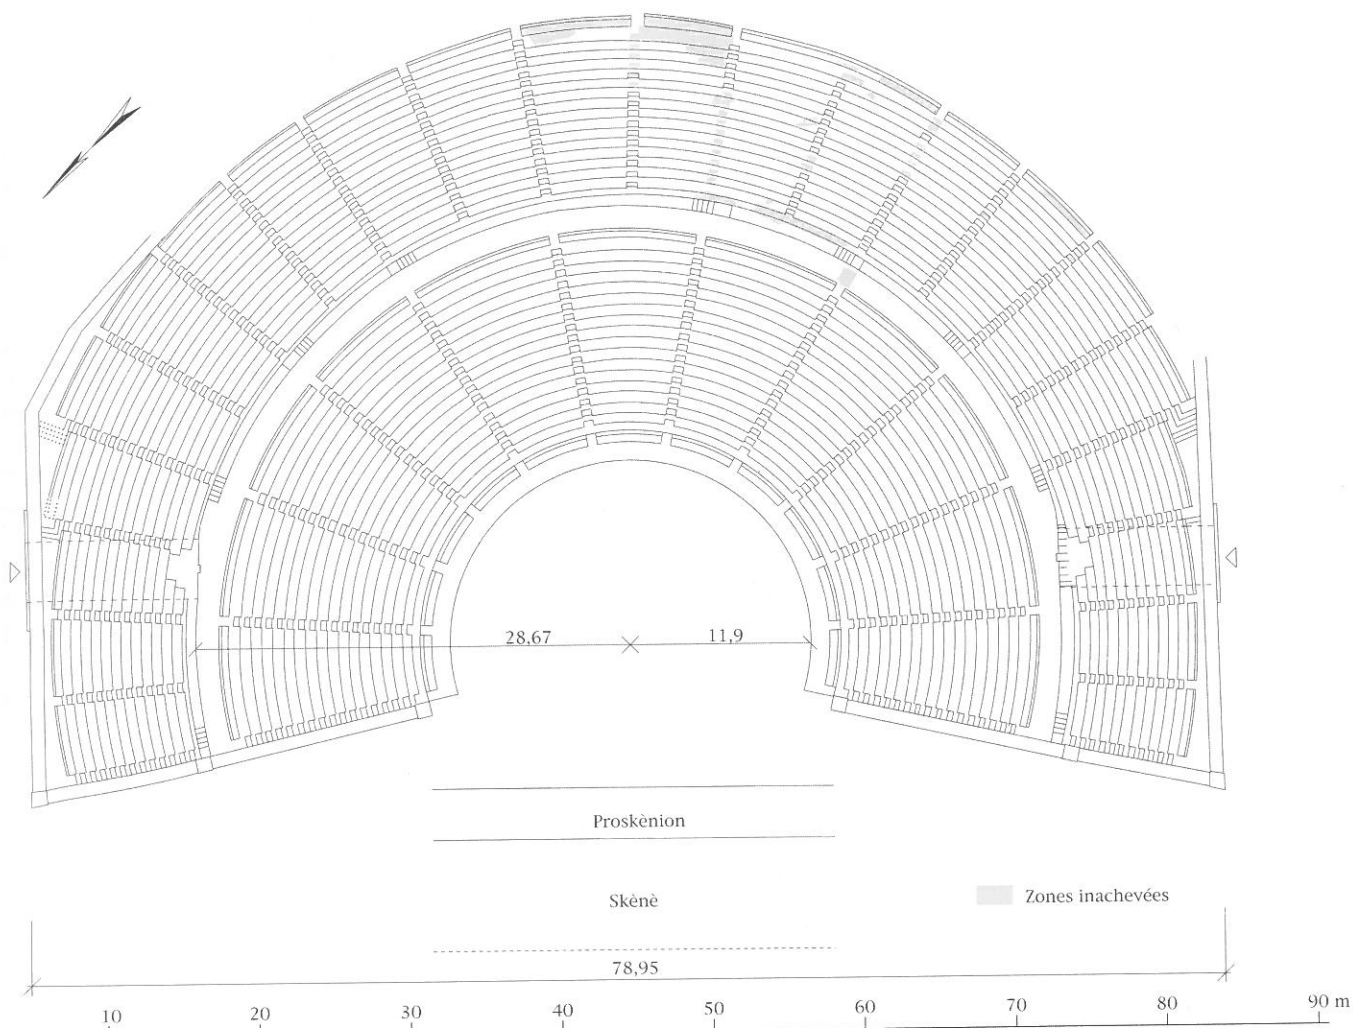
Plan restitué du *koilon* (éch. : 1/500).
